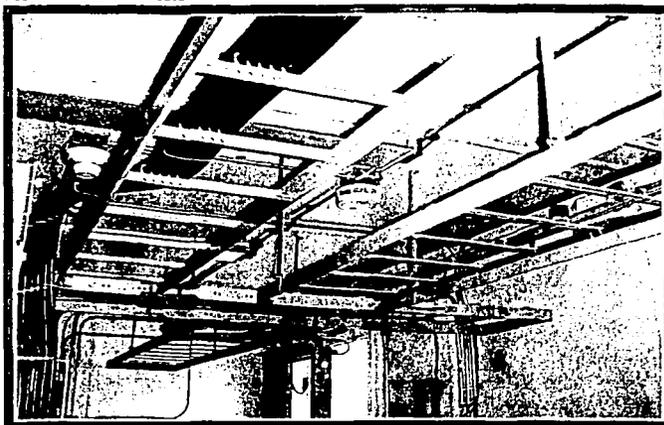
Escalerilla para el transporte de cables en contenedores o shelters.
